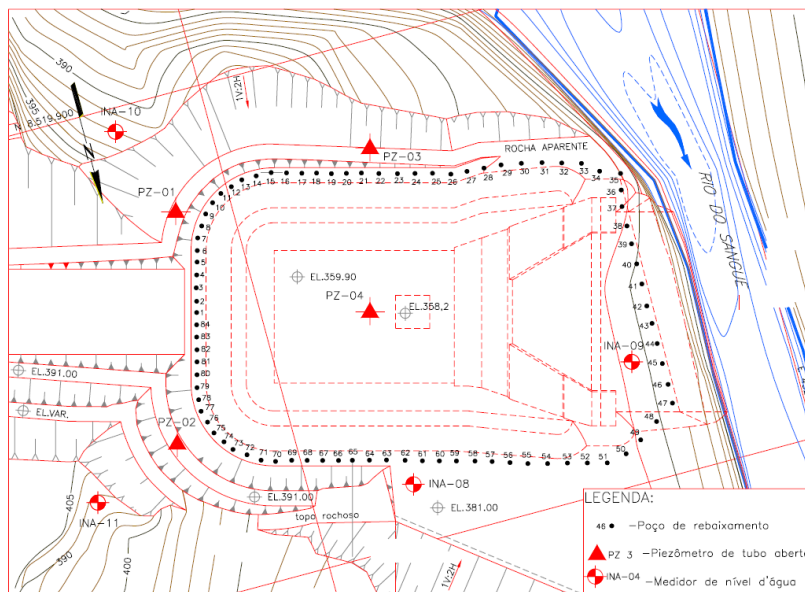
Planta do sistema de rebaixamento do nível do lençol freático (Corrêa, 2006).
